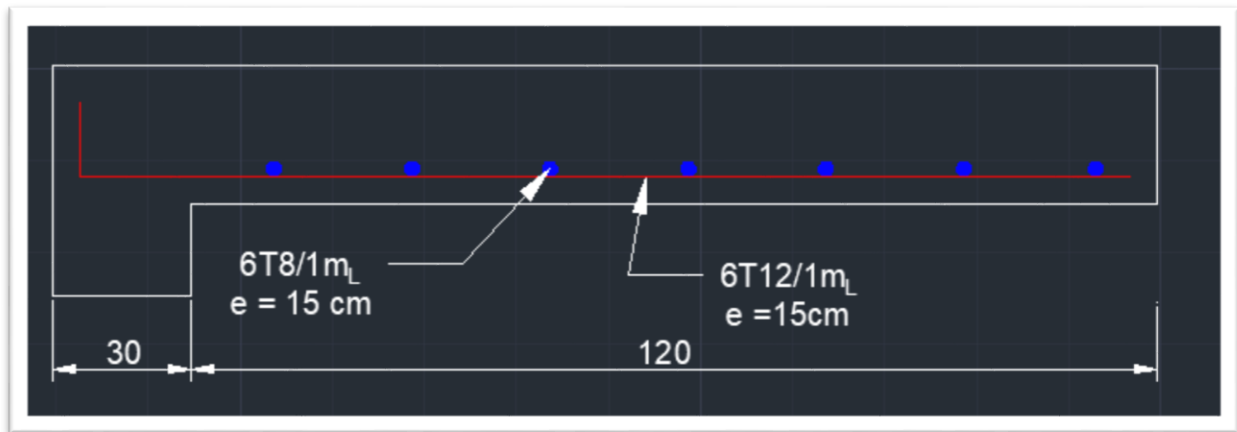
Schéma du ferrailage de la dalle pleine du balcon (coupe parallèle à L_x)
